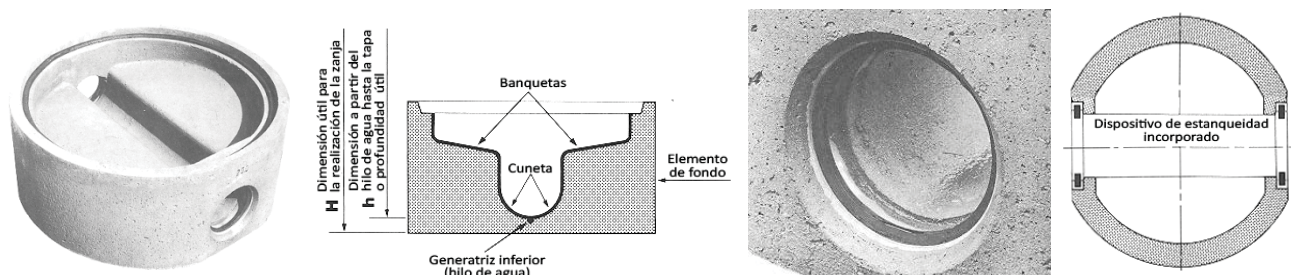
BASE O ELEMENTO DE FONDO DE UN POZO DE VISITA DE CONCRETO PREFABRICADO
